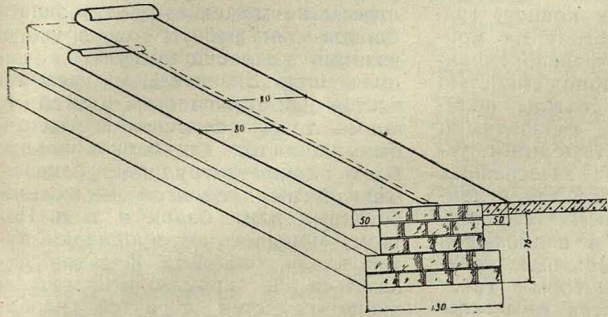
Схема продольной наклейки руберойда по горизонтальной плоскости фундамента
